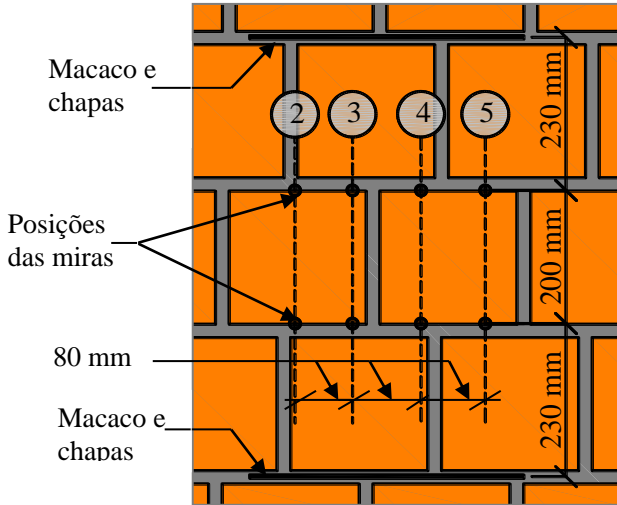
Ensaio C: vista longitudinal da posição dos macacos planos e chapas, das miras de leitura e das juntas horizontais e verticais.
